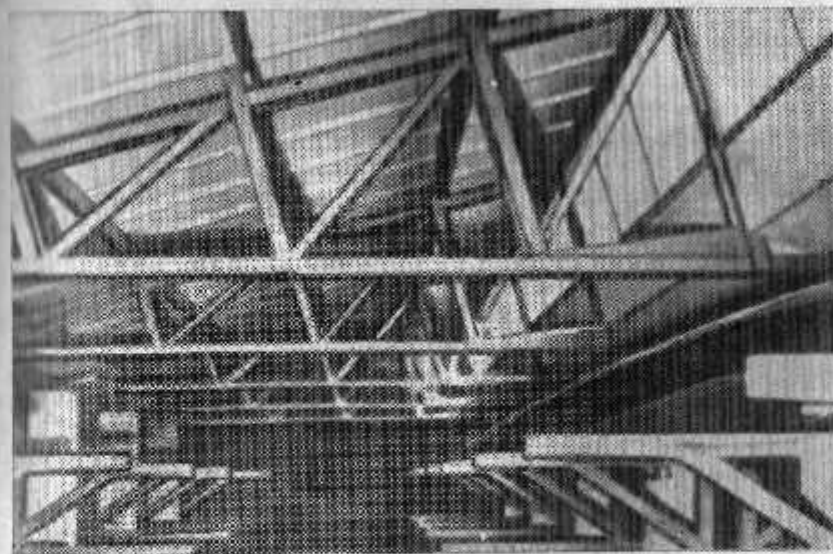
Покрытие на клееных дощатых фермах пролетом $l=5,3$ м
